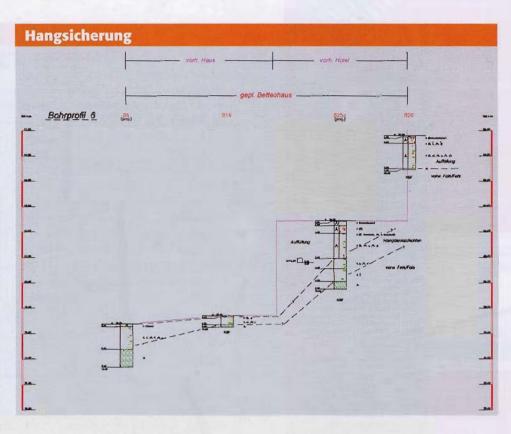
Senkrechter Schnitt zur geplanten Hangsicherung.
